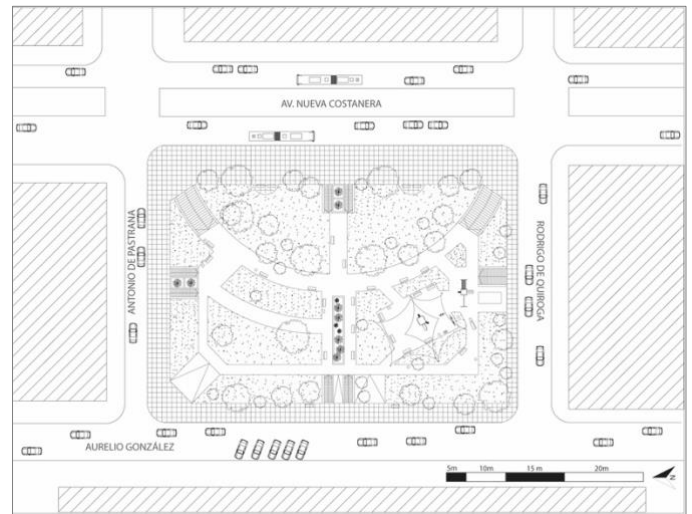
Plano emplazamiento plaza “Colombia” Fuente: Elaboración propia.
